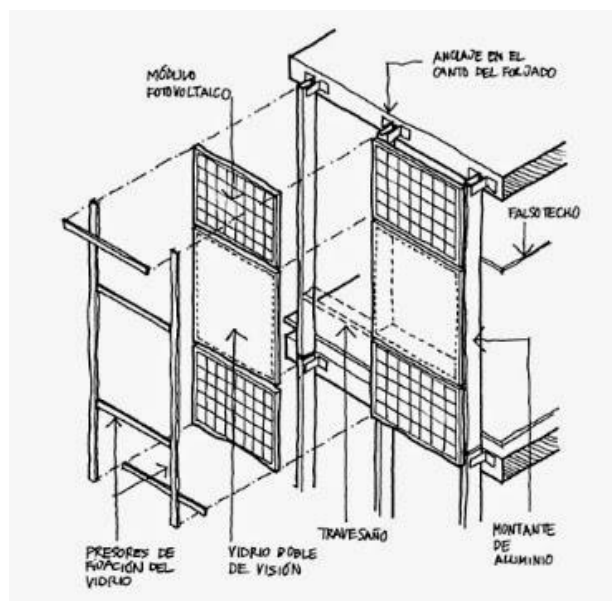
Detalle constructivo de muro cortina fotovoltaico.
